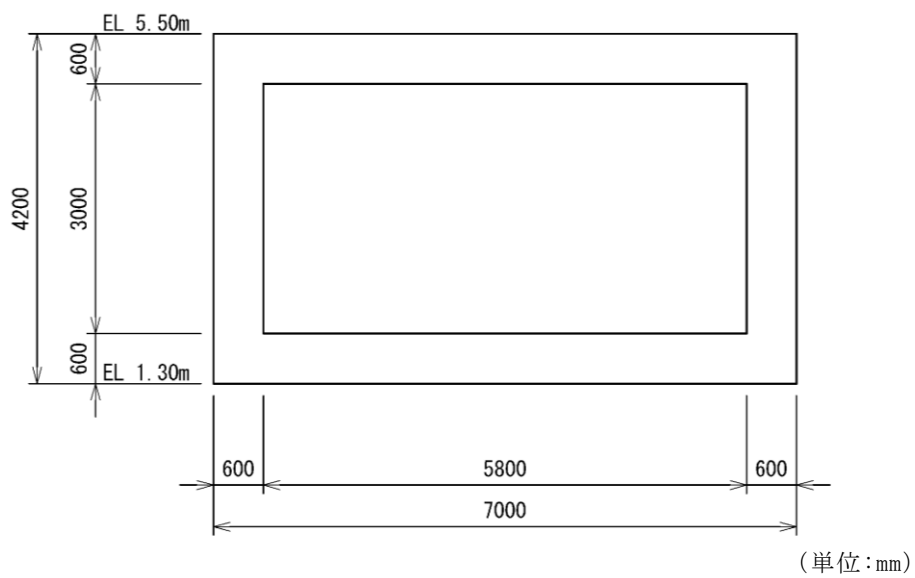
屋外配管ダクト (タービン建物～放水槽) 断面図 (A-A 断面)
